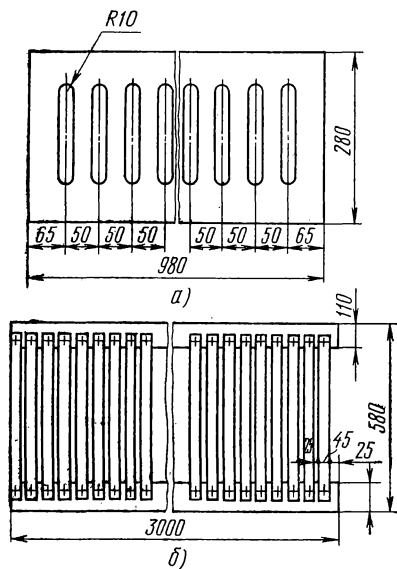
Решетки перекрытий каналов камерной сушилки:
